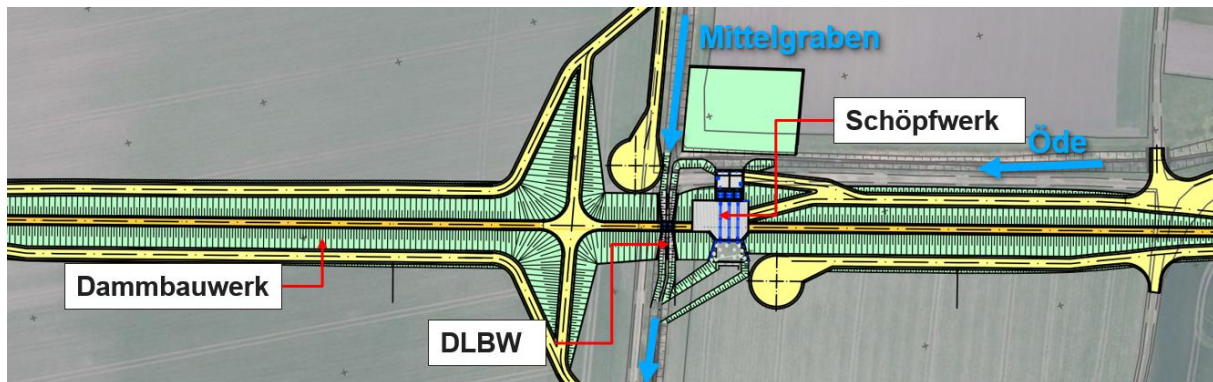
Lageplanauszug mit den geplanten Anlagen in Schwerstedt, DLBW = Durchlassbauwerk
